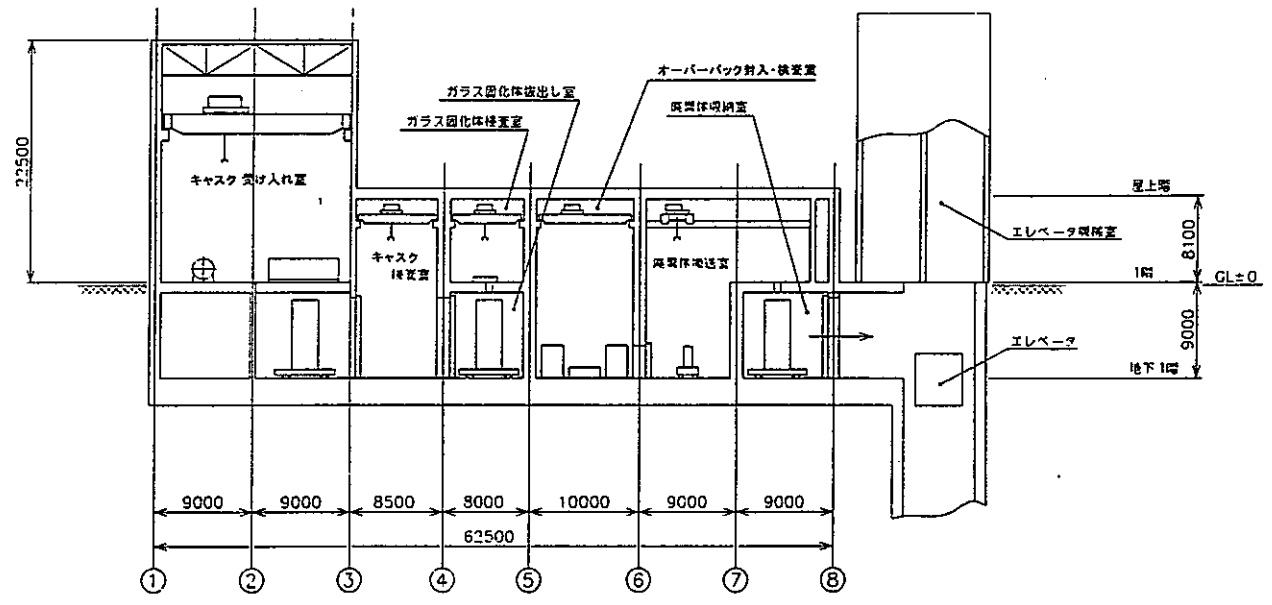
(4/4) 地上施設：廃棄物受け入れ・検査施設機器配置図（A-A断面図）
